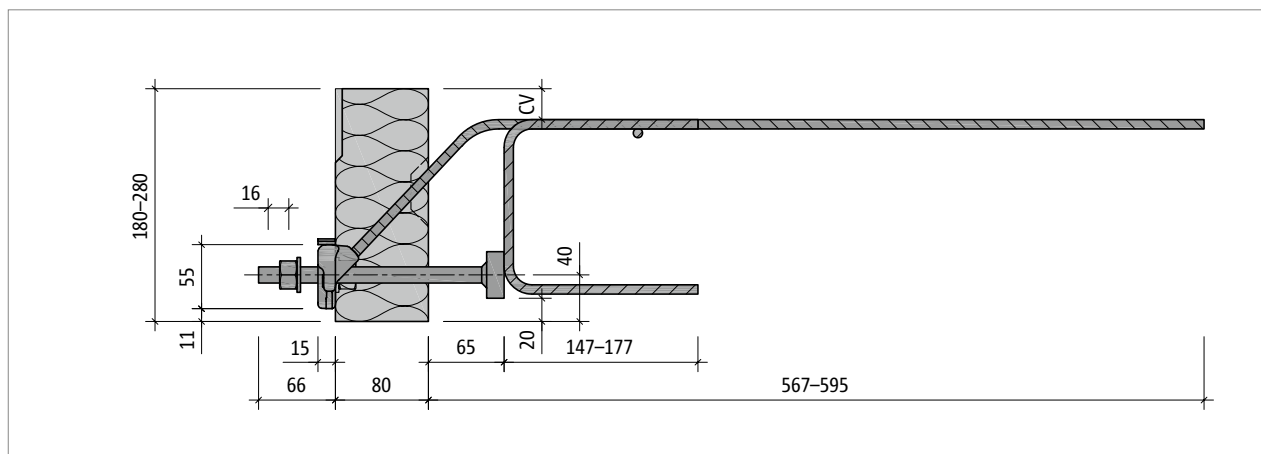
Schöck Isokorb® T type SQ-V1 : vue en coupe du produit
